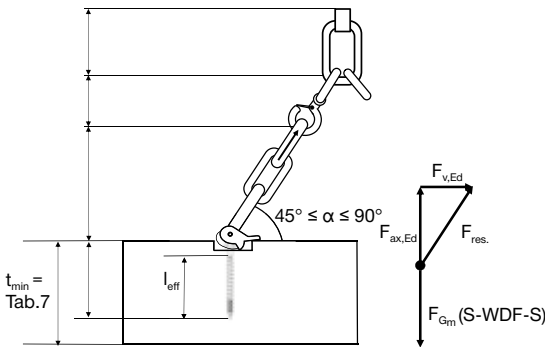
Axiale Belastung des S-W LS mit einer Passfräsung
